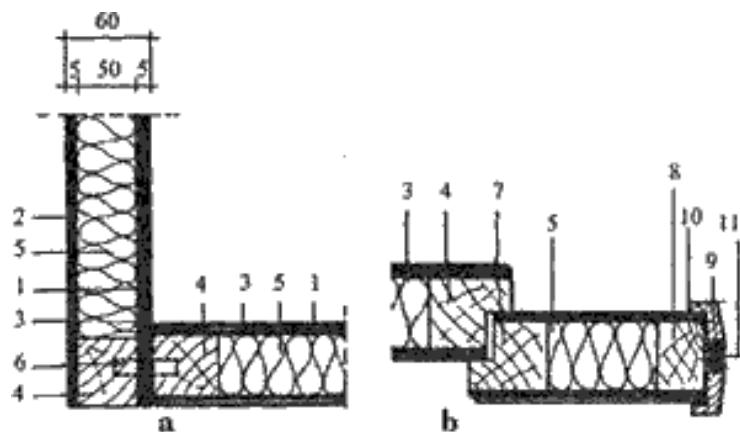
Детали сауны, изготовленной из щитовой клееной фанеры, монтируемой из деревянных элементов: (А — монтаж угла; В — дверное сопряжение): 1 — внутренняя обшивка клееной фанерой; 2 — наружная обшивка клееной фанерой; 3 — парозащитная фольга/пленка; 4 — рамочный каркас; 5 — теплоизоляция; 6 — соединительный вставной шип с отверстием; 7 — каркас дверной обвязки; 8 — стенная рама под остекление; 9 — штипик; 10 — паз под замазку; 11 — распорная рейка.
